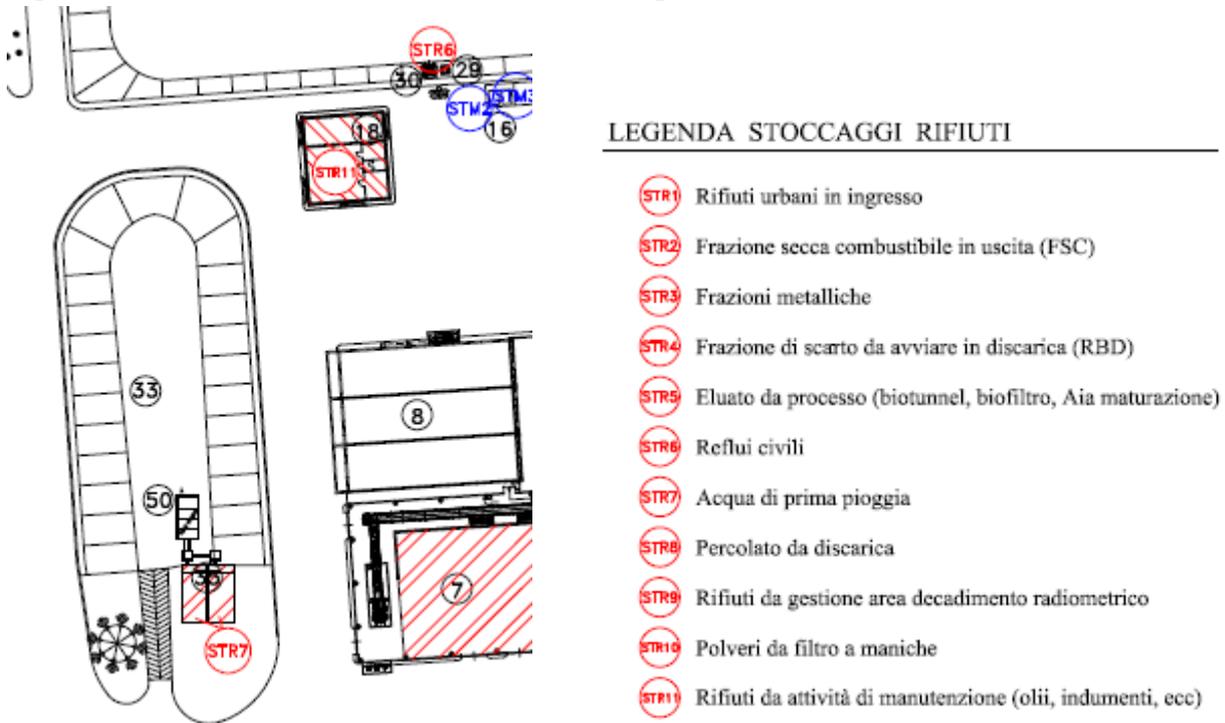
Stralcio da Allegato 8 – Planimetria aree di stoccaggio – Acque di prima pioggia
